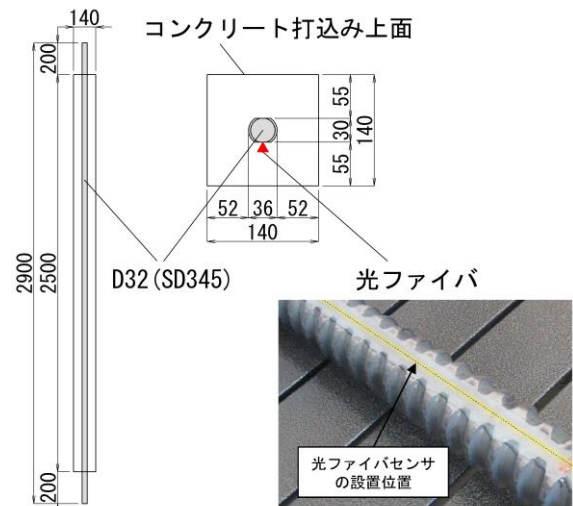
両引き試験供試体⁹⁾ (寸法単位: mm)
